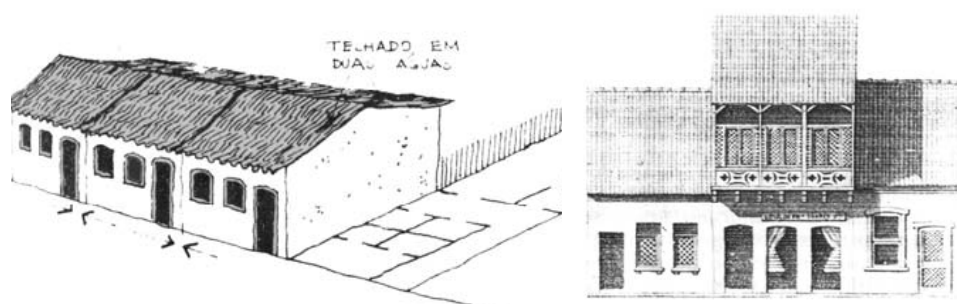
Casas de planta baja sin varanda y de dos plantas con balcón. Fuente: LEMOS, 1996.
